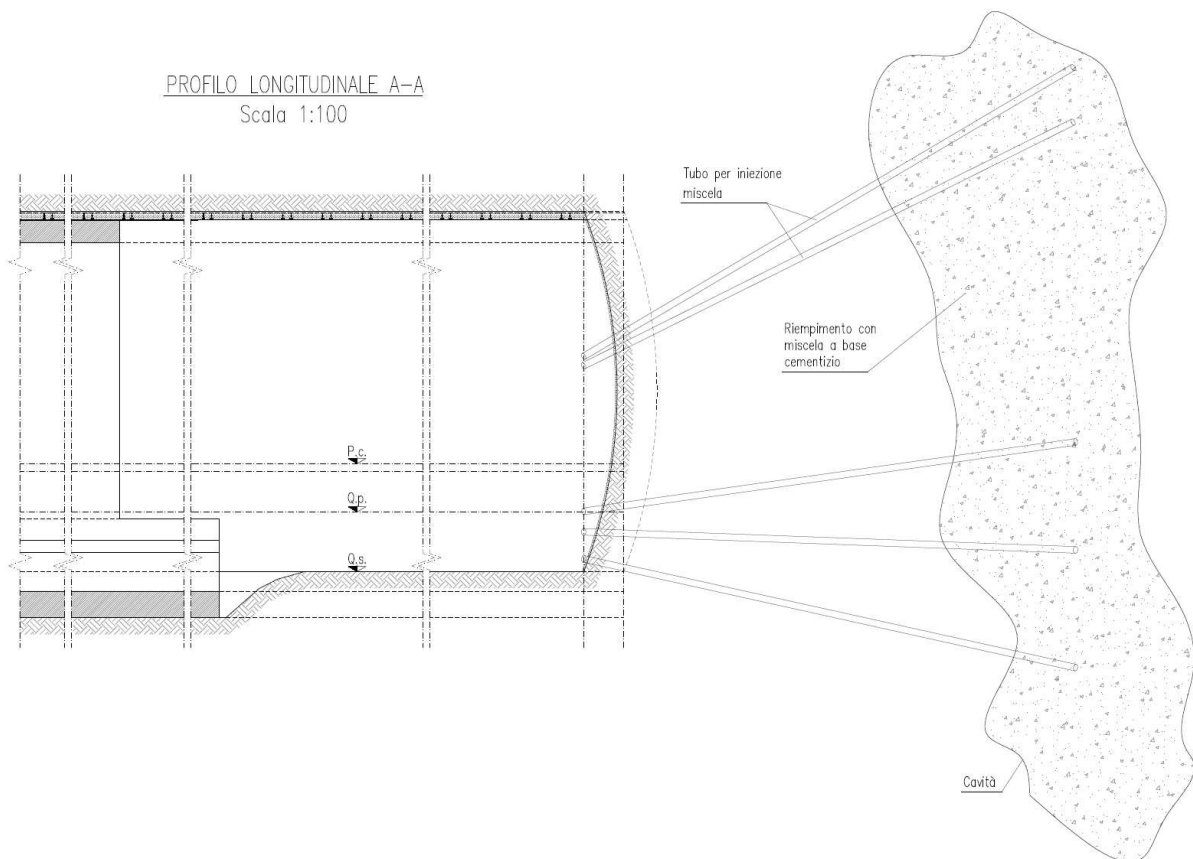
Iniezioni di riempimento cavità carsiche in avanzamento. Schema in sezione longitudinale
